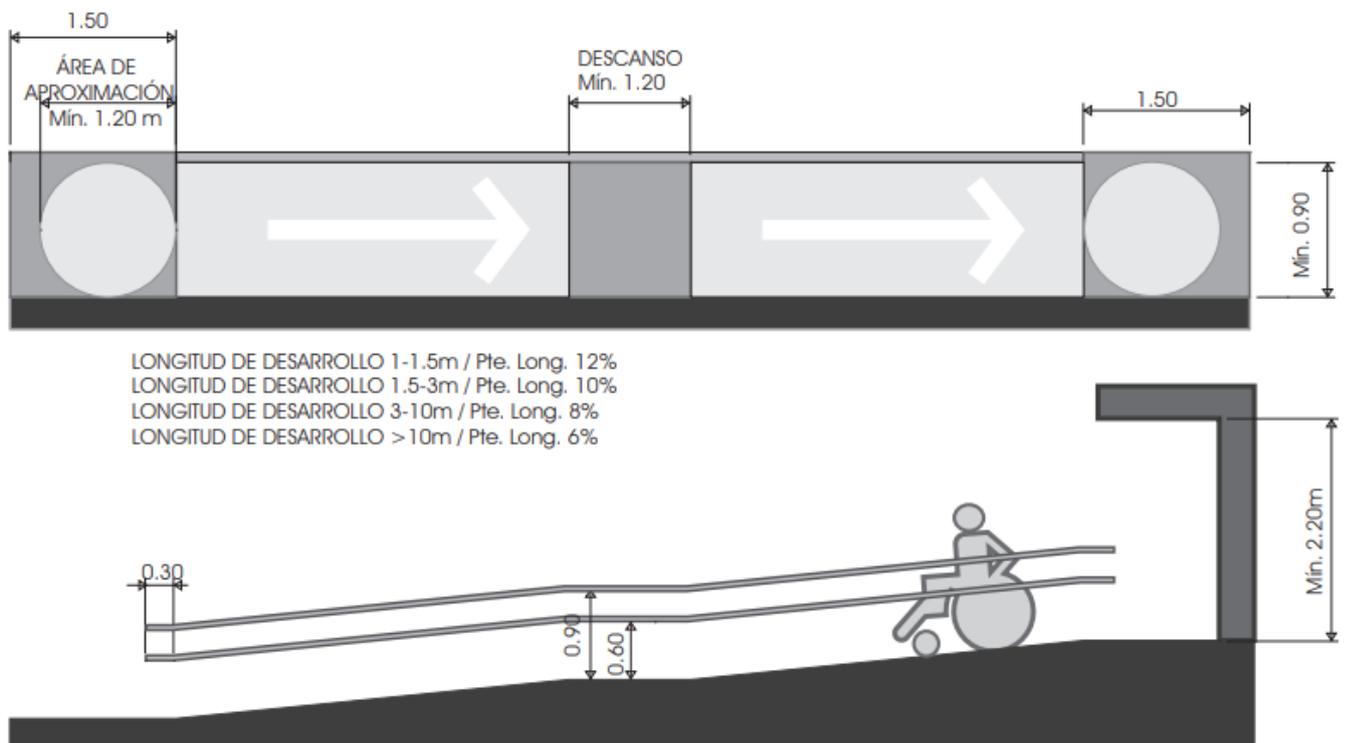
Disposición de Escaleras y Rampas típicas para el acceso de Puentes Peatonales
